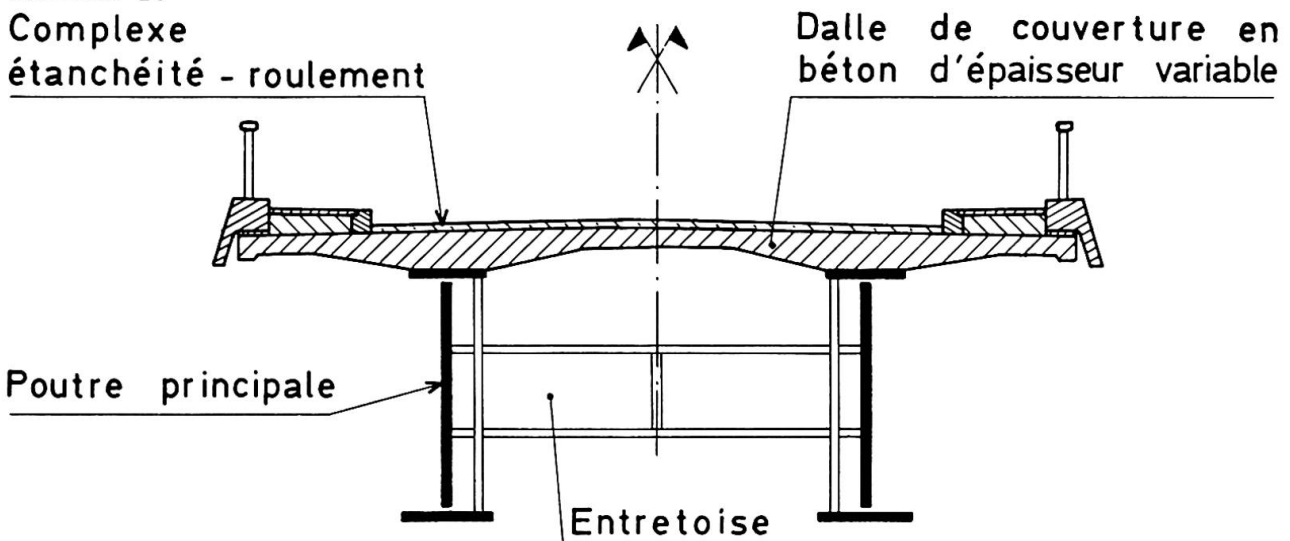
Pont à deux poutres sous chaussée et entretoise, avec dalle de couverture d'épaisseur variable.
